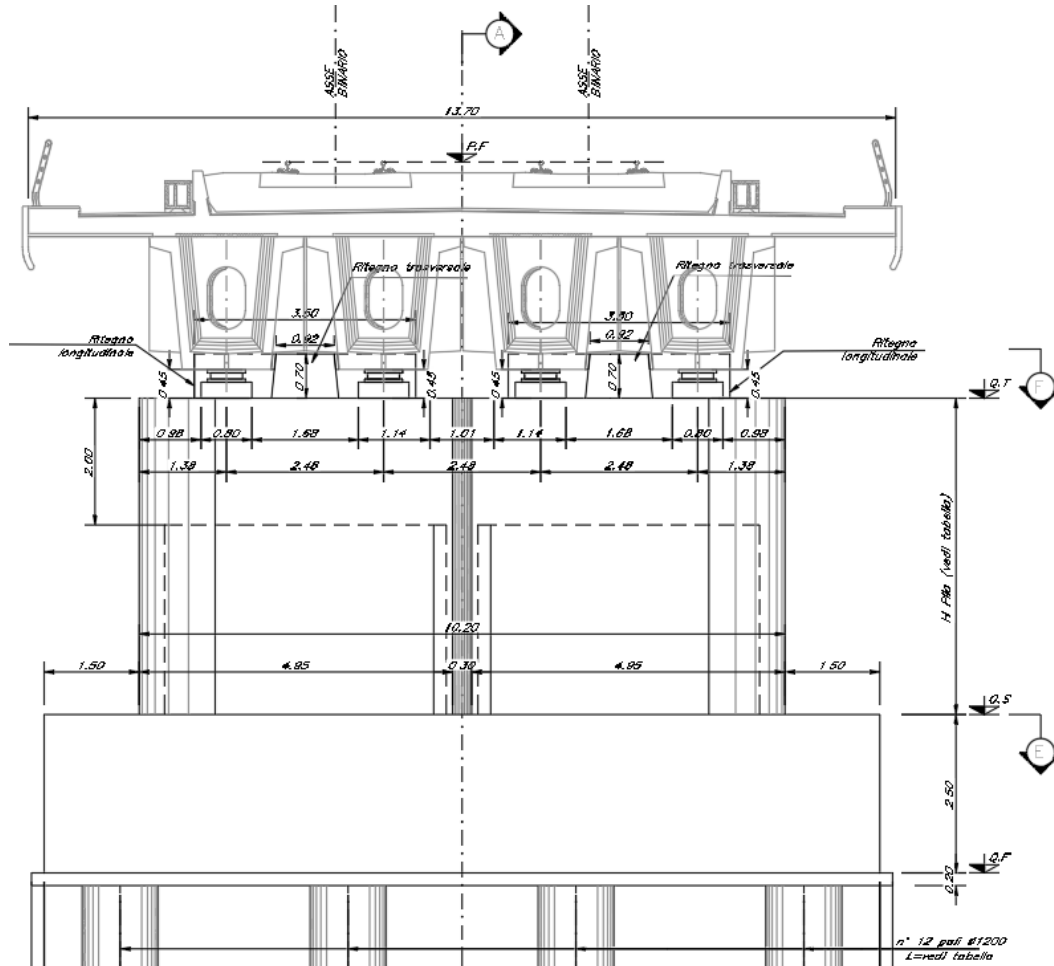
Pila scatolare doppio binario – prospetto trasversale
